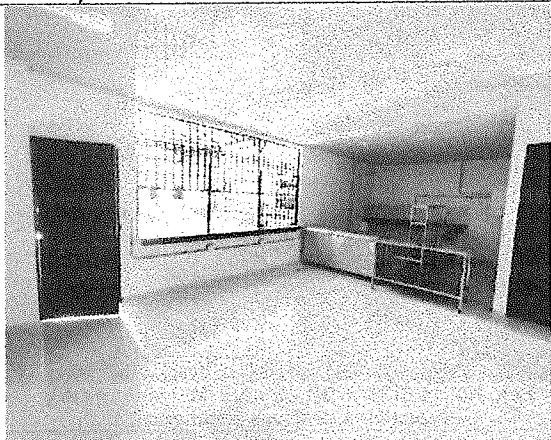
NUSEFA MEBUC (mantenimiento restaurante)
